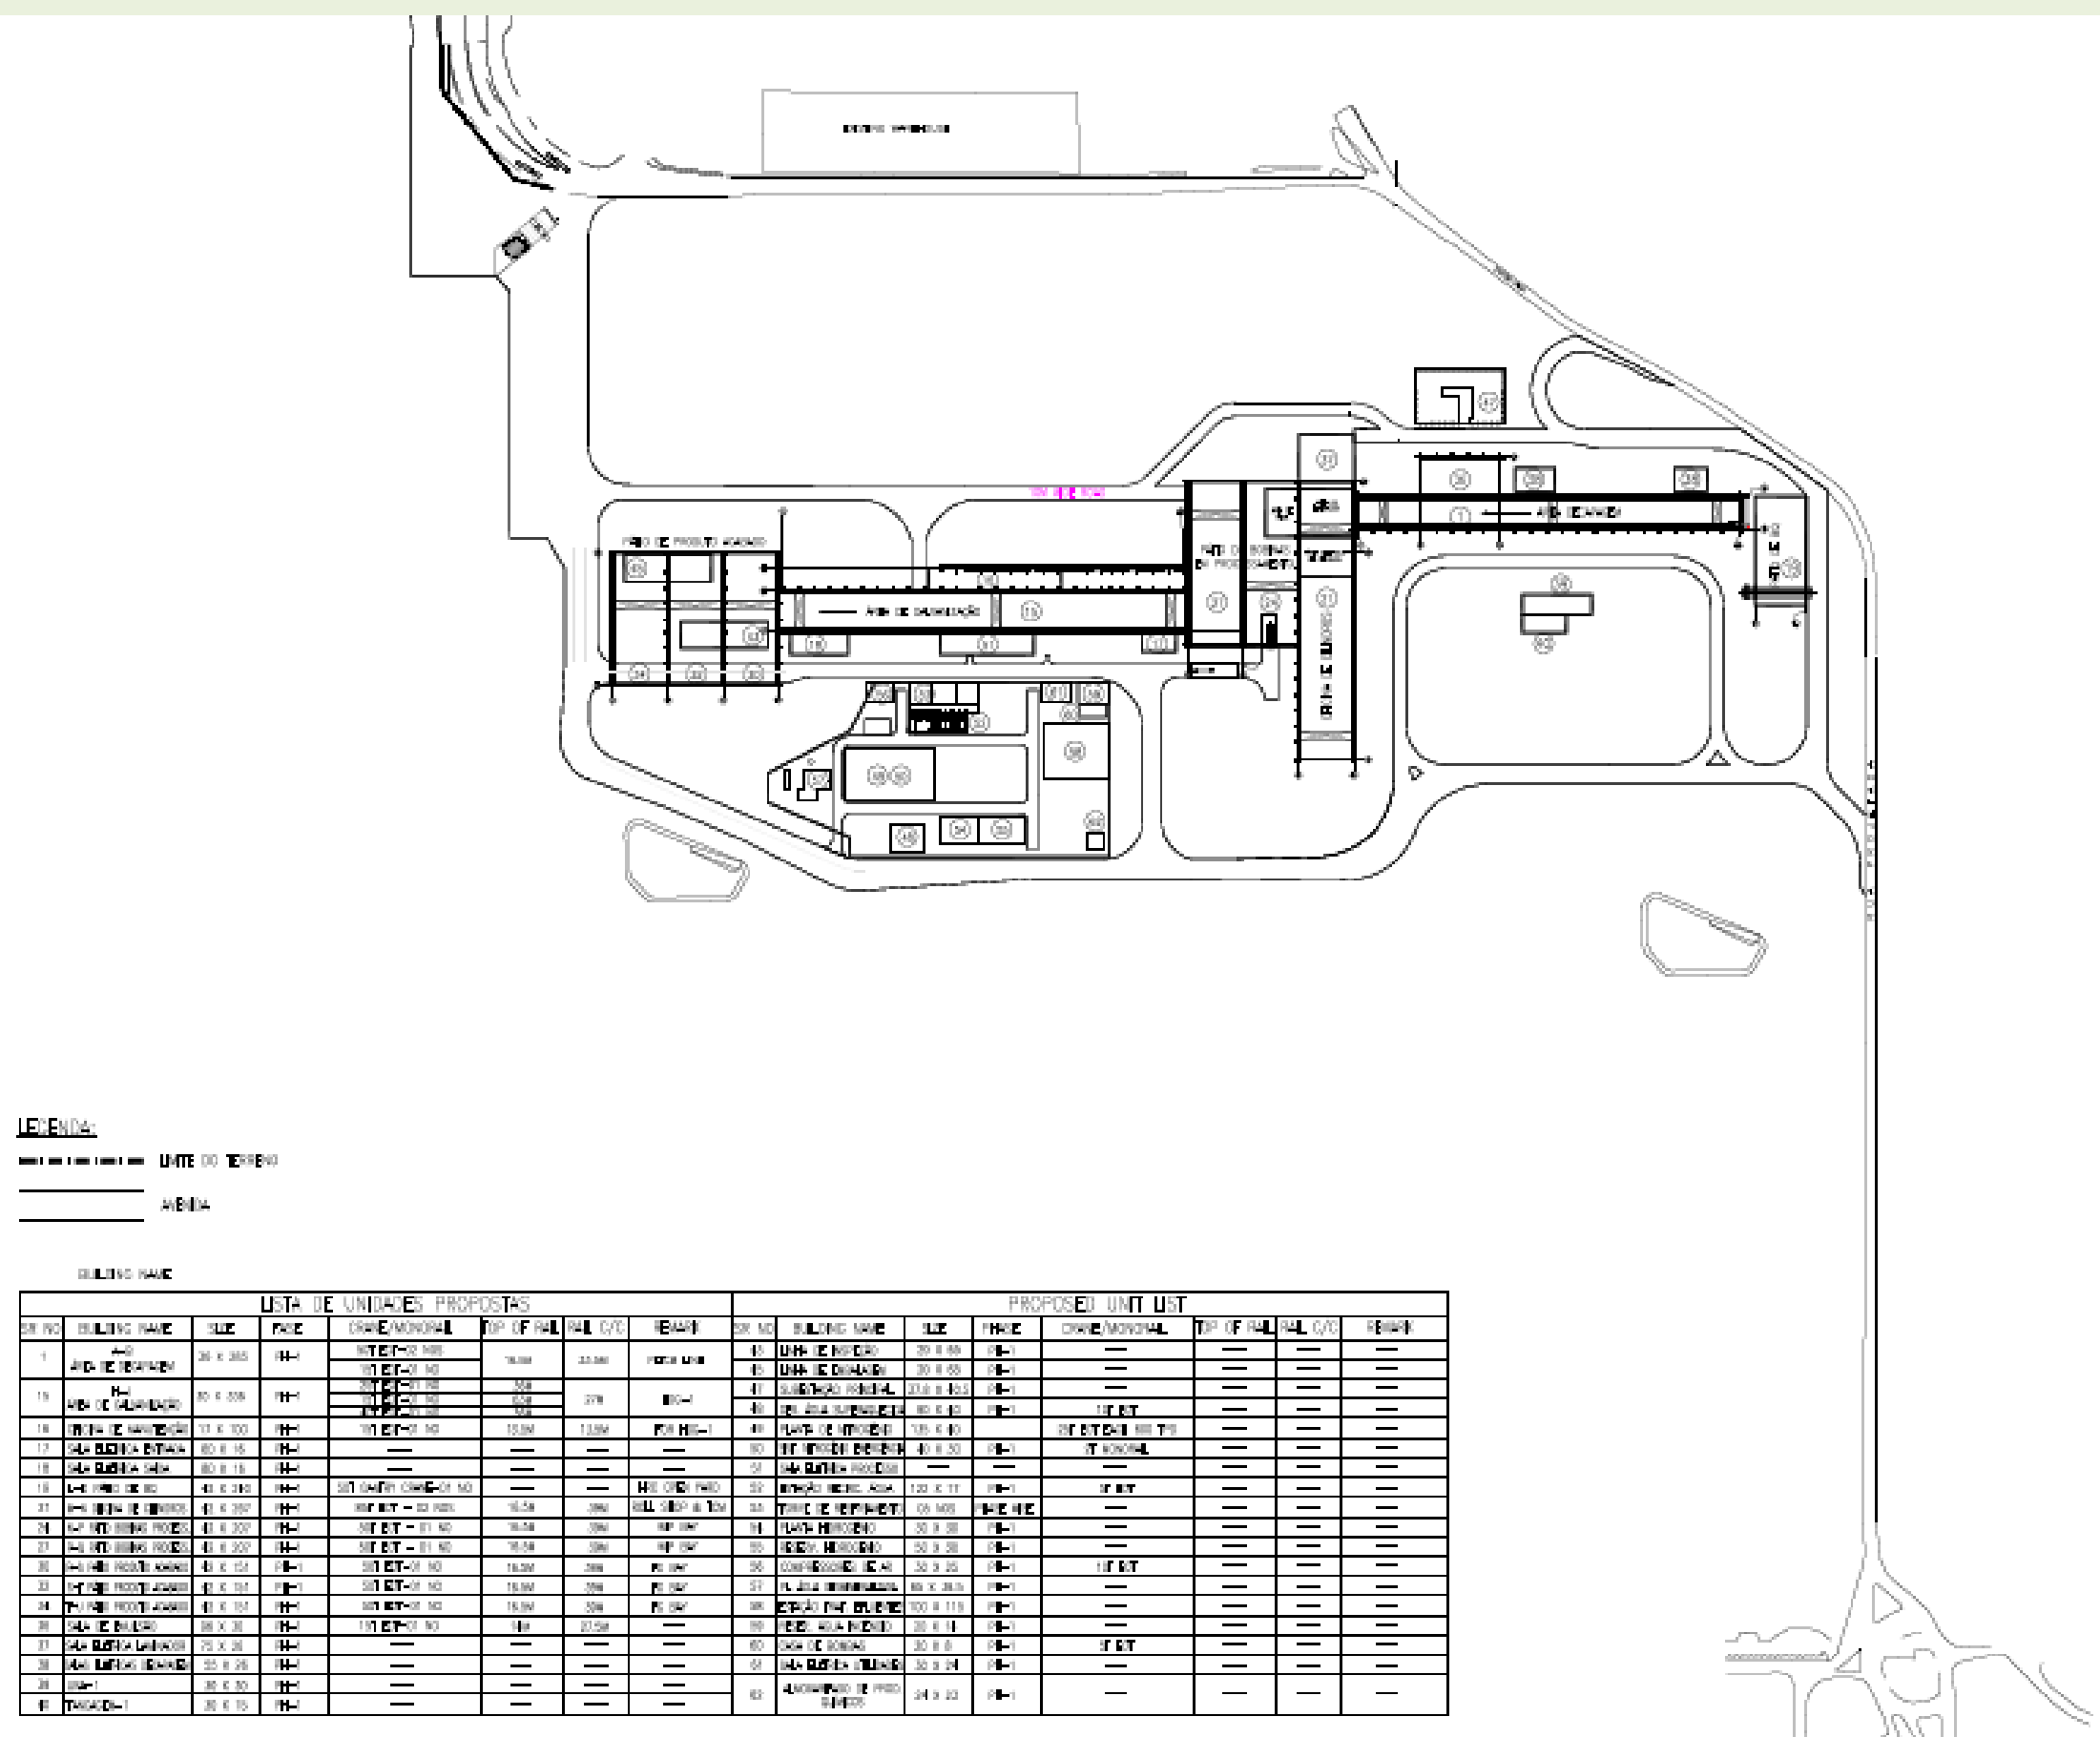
Layout do complexo de Laminação a Frio e Galvanização. Planta Layout primeira fase - Formato AMT1_Revisado1-Mono
